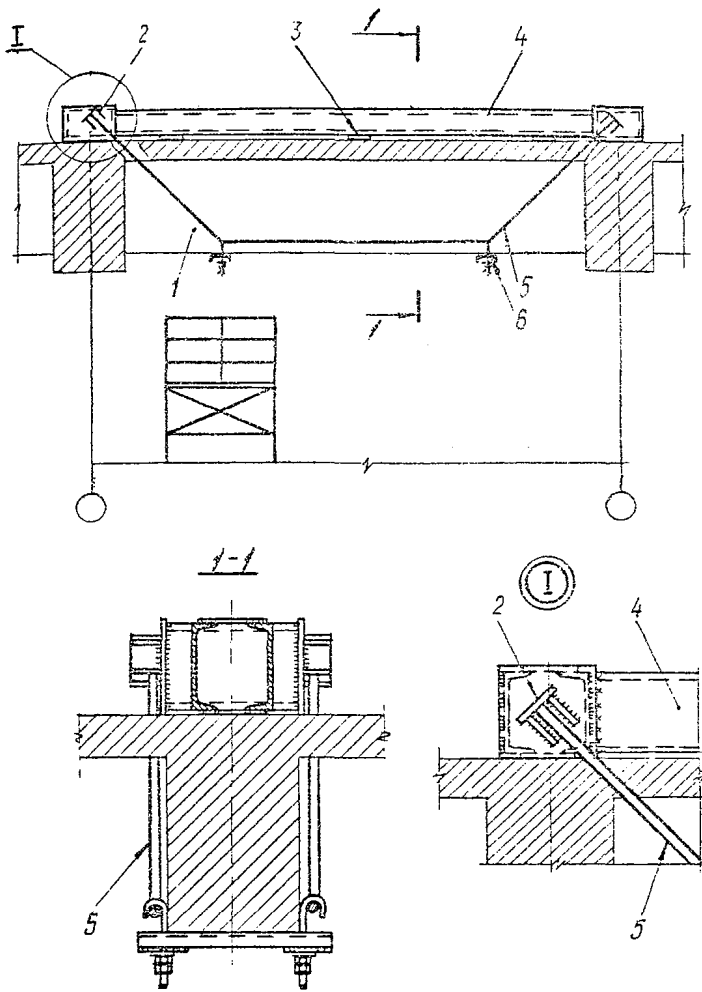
Схема усиления балки шпренгельной затяжкой с закреплением на металлическую балку:
